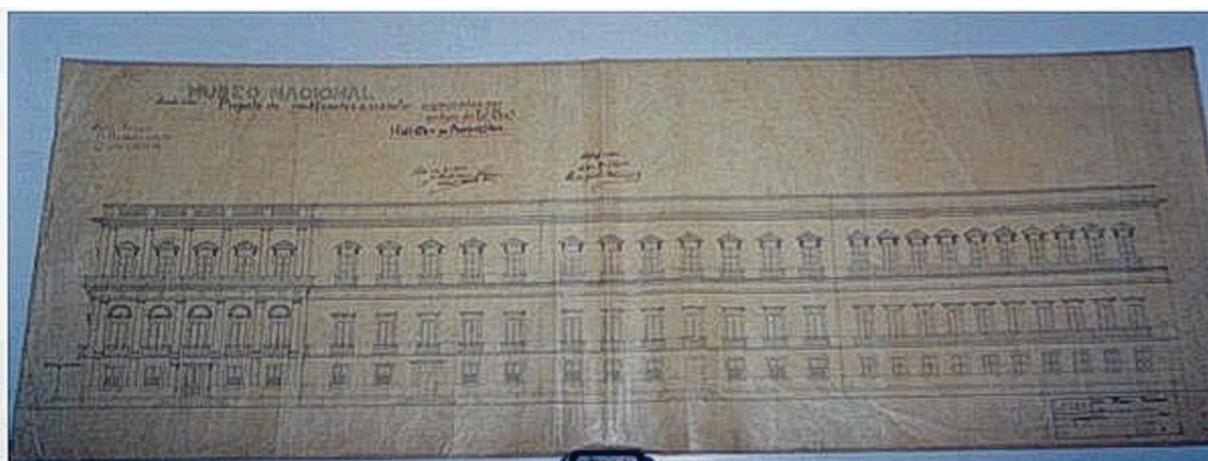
Fachada Norte do Paço em 1910 – Projeto de modificação.
